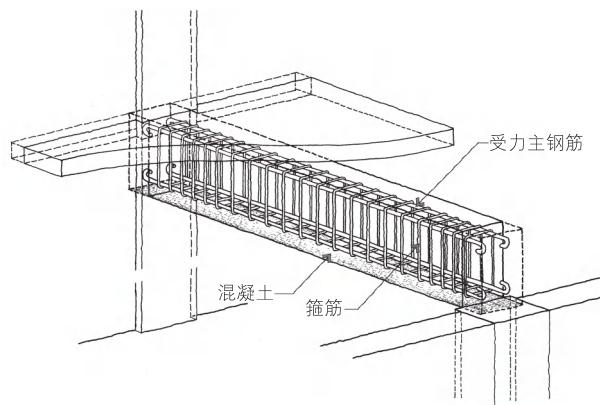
结合了钢筋骨架，现代的钢筋混凝土几乎变得万能
